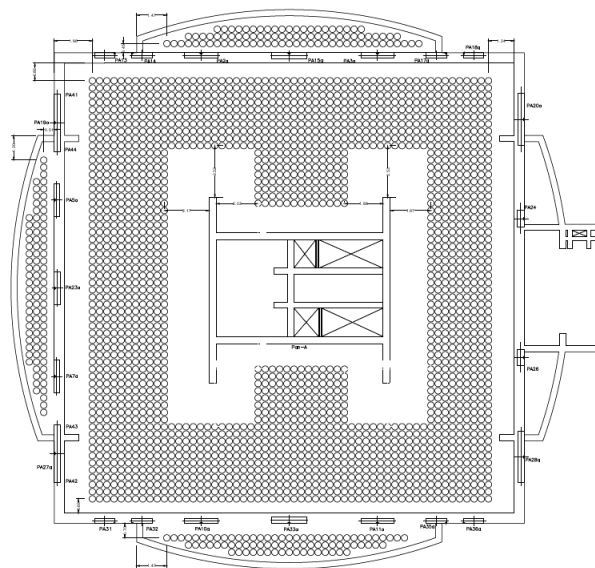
Planta tipo Torre A con aligeramientos y áreas macizadas [1].
